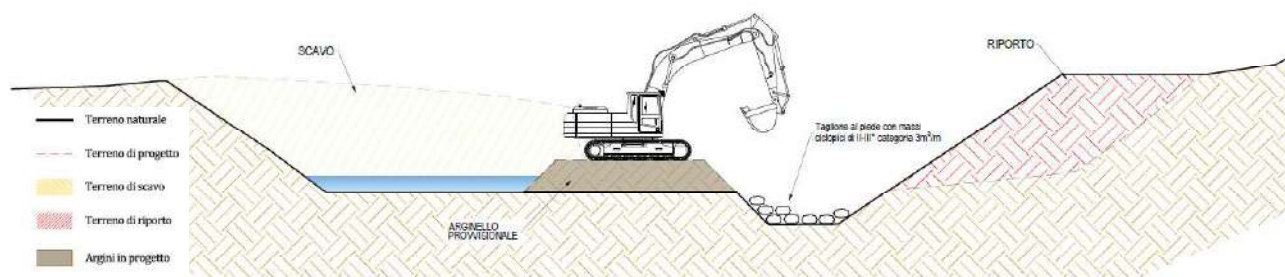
Sezione illustrante l'esecuzione dell'ultima fase lavorativa (realizzazione taglione al piede della scarpata in destra idraulica)
